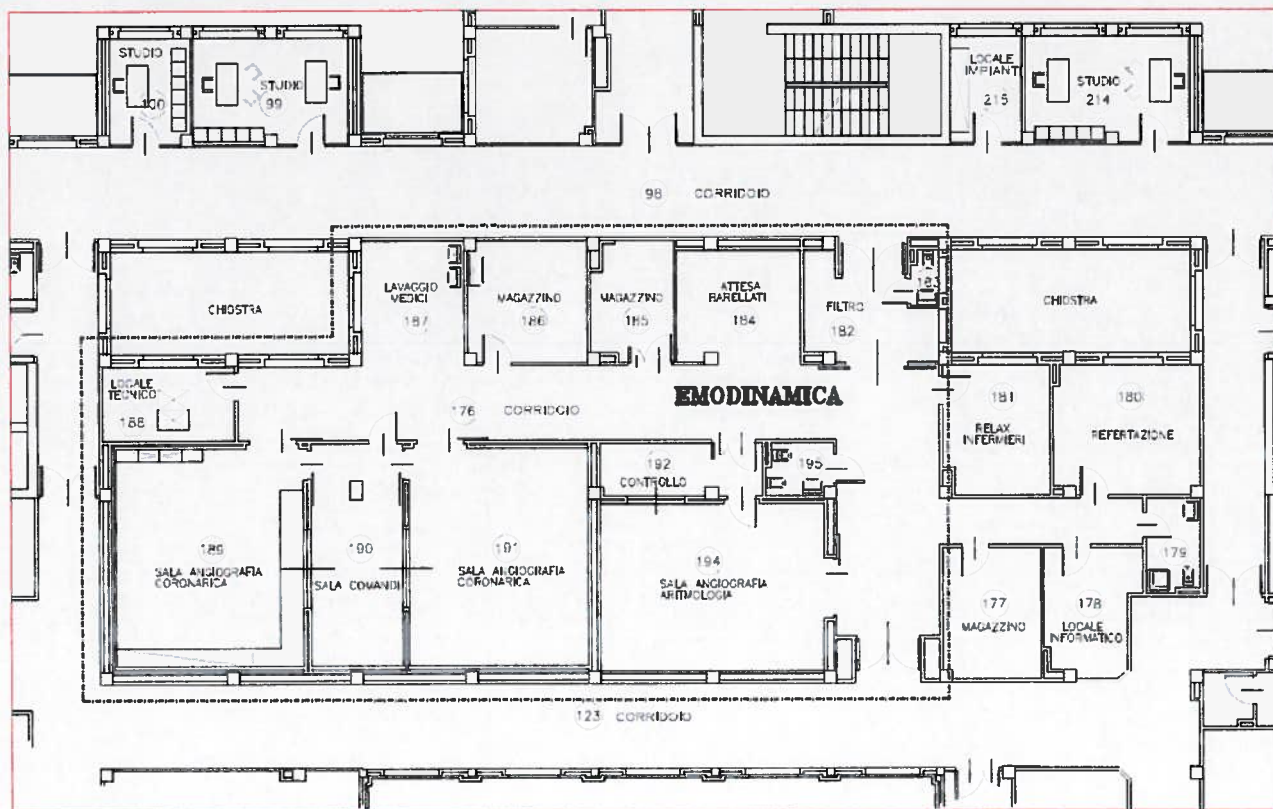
Layout Emodinamica stato attuale e area di cantiere
